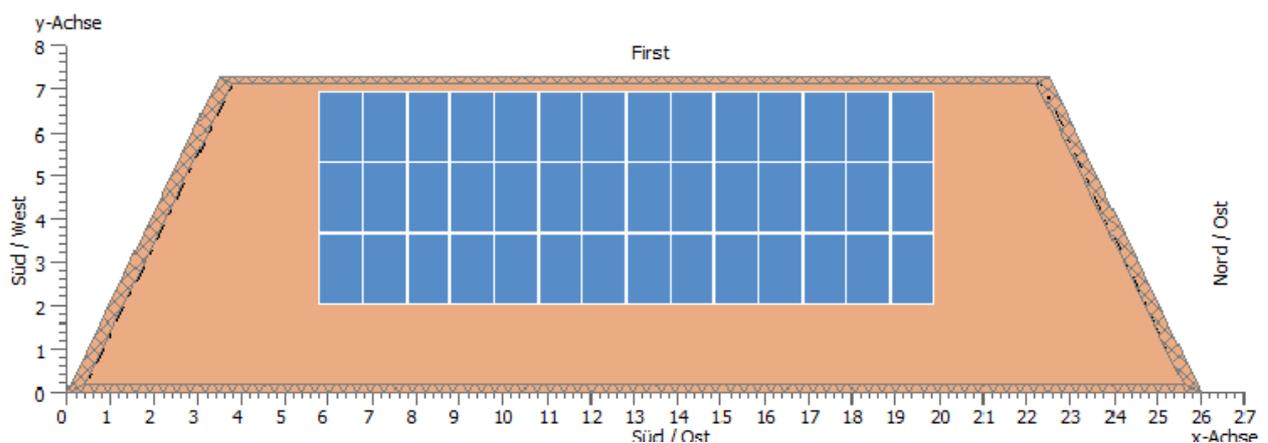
Belegungsplan Dachfläche 10kWp Photovoltaik-Anlage
